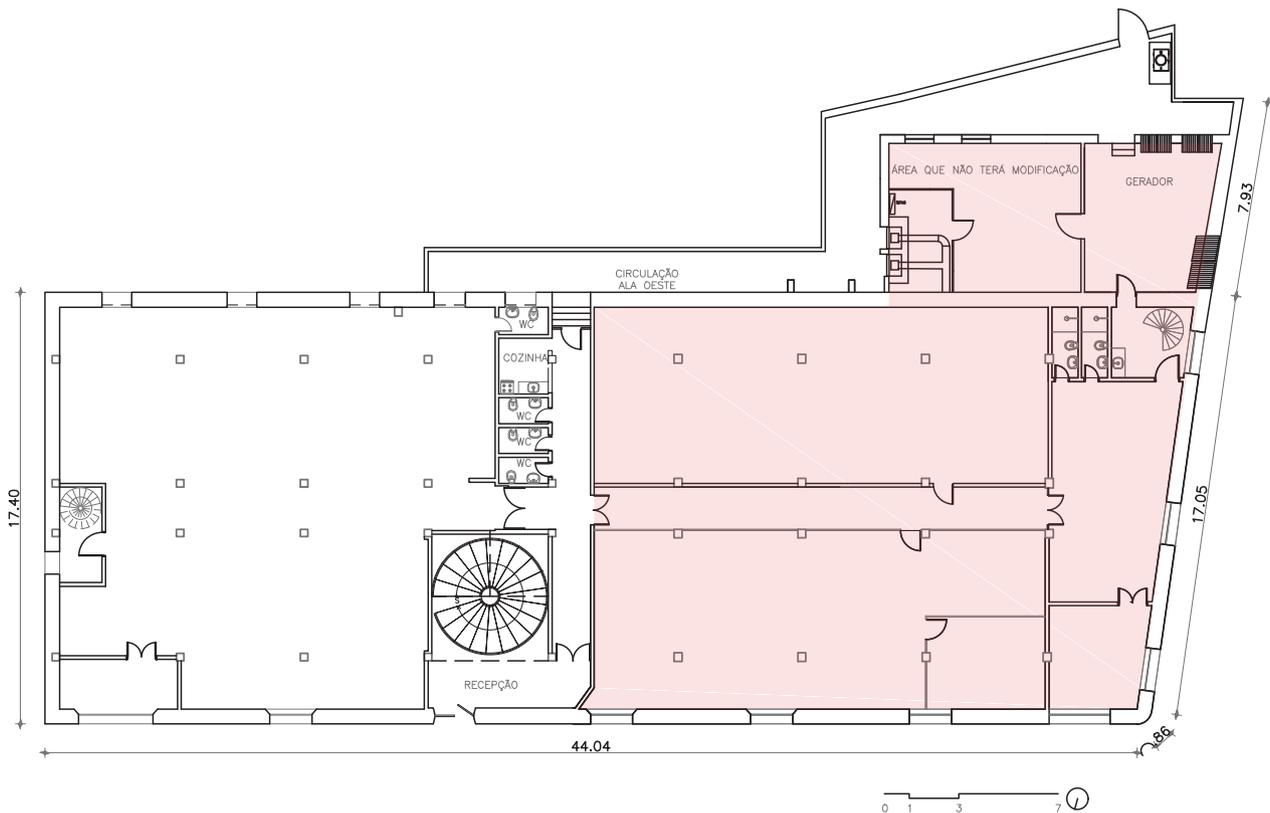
Planta baixa do térreo. Área ativa destacada de rosa. Fonte: SEINF – Sefaz/Ce (modificado).
